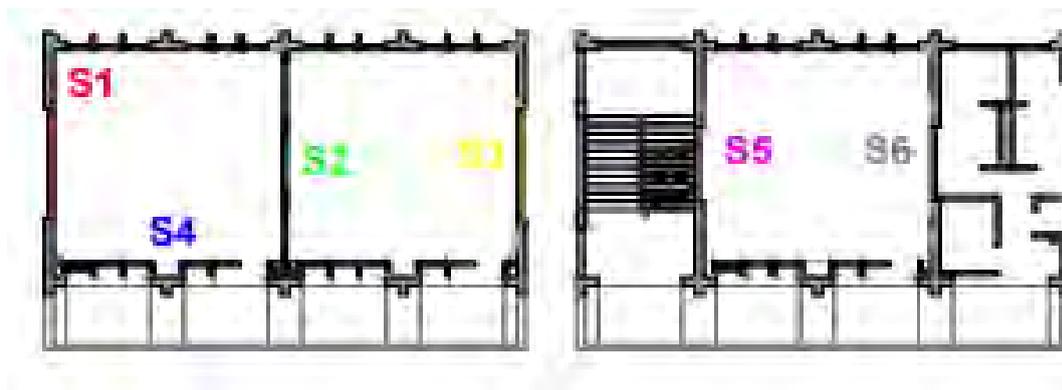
Sectorización de la actividad de asentado de muro de bloquetas 2da parte para aulas
